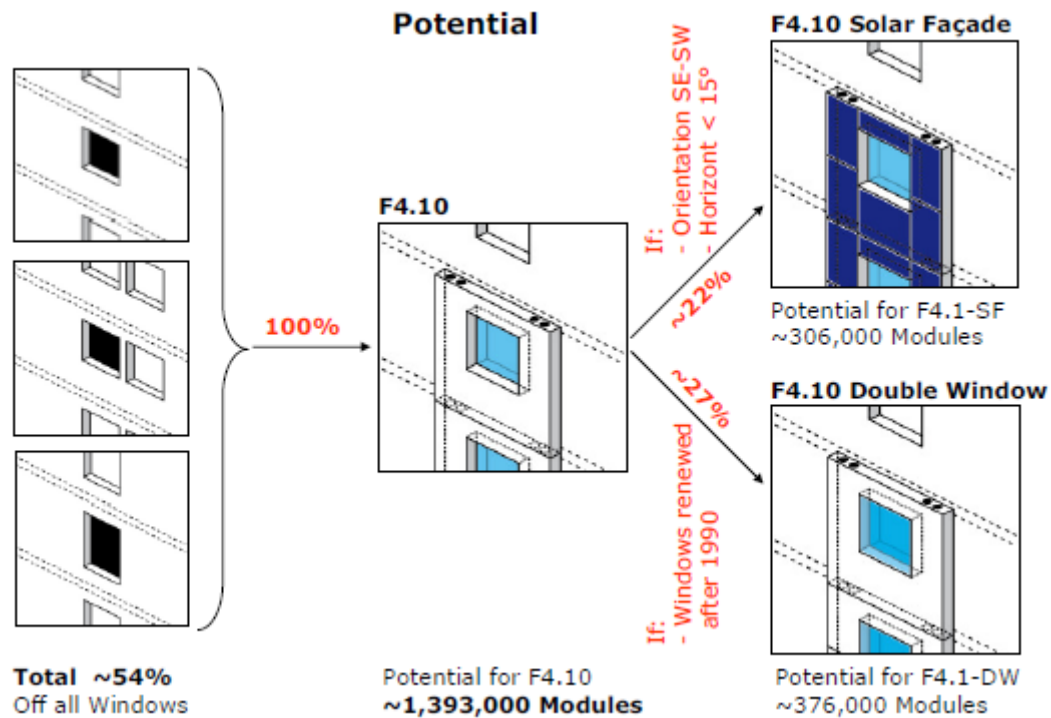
Agrupamento de Casos Tipo de Aberturas Similares para Aplicação do um Painel Pré-fabricado que mais se Ajusta e suas Variantes. [27]
